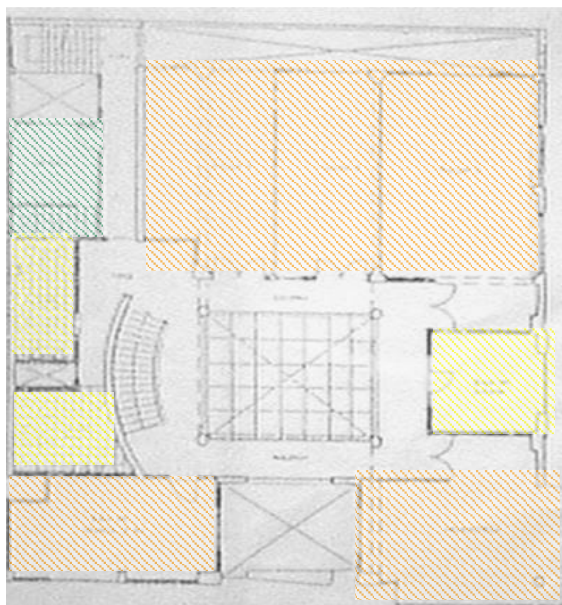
ZONIFICACIÓN DE PRIMERA PLANTA
